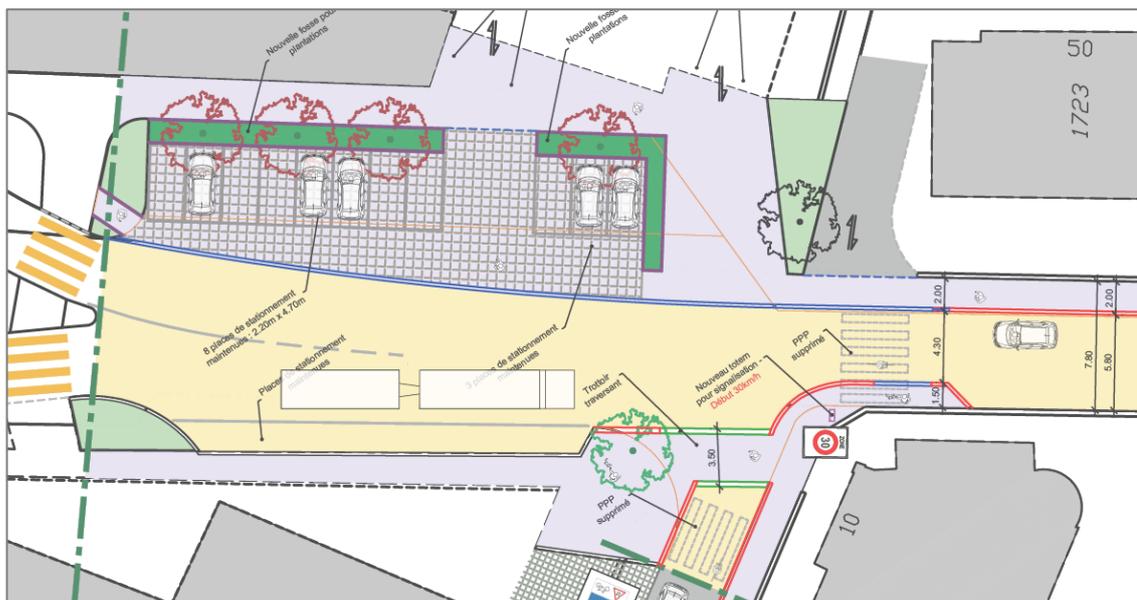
schéma illustratif du carrefour Clos d'Aubonne - Gustave Courbet, fond de plan extrait du plan MCR
